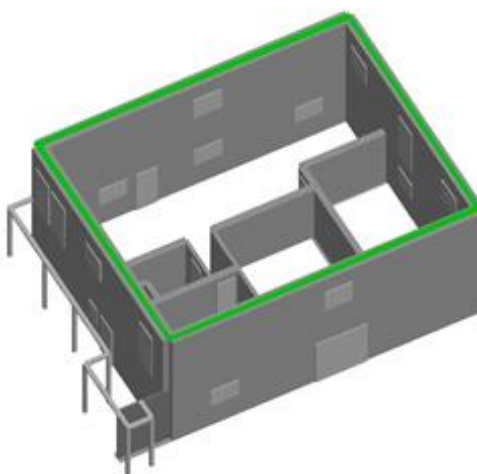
Esquema de introdução de tirantes ao nível do pavimento do sótão em todas as fachadas
